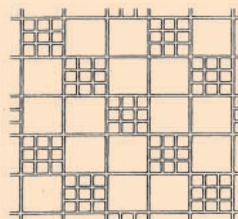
Formato cuadrado alternando con pavimento mosaico.
